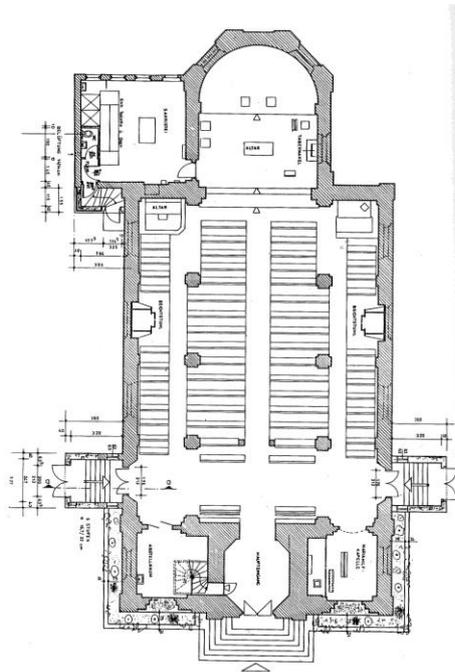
Grundriss der Pfarrkirche aus dem Jahr 1985
